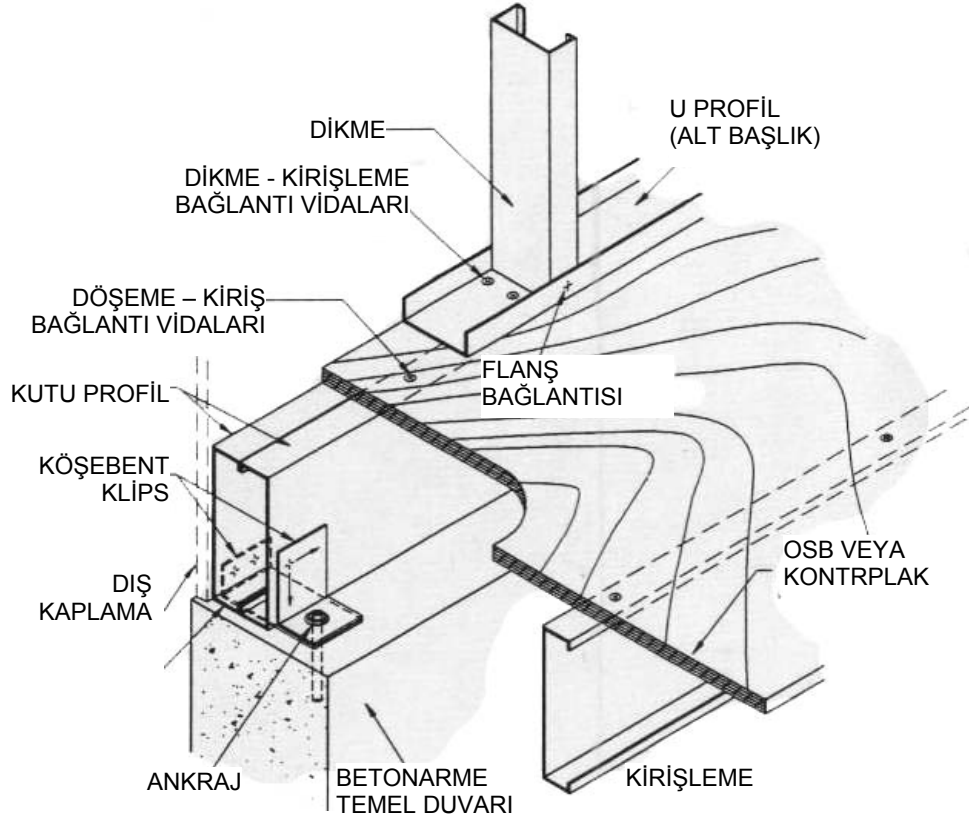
Döşemenin temel duvarının iç yüzeyine oturtulması alternatifleri [67]
